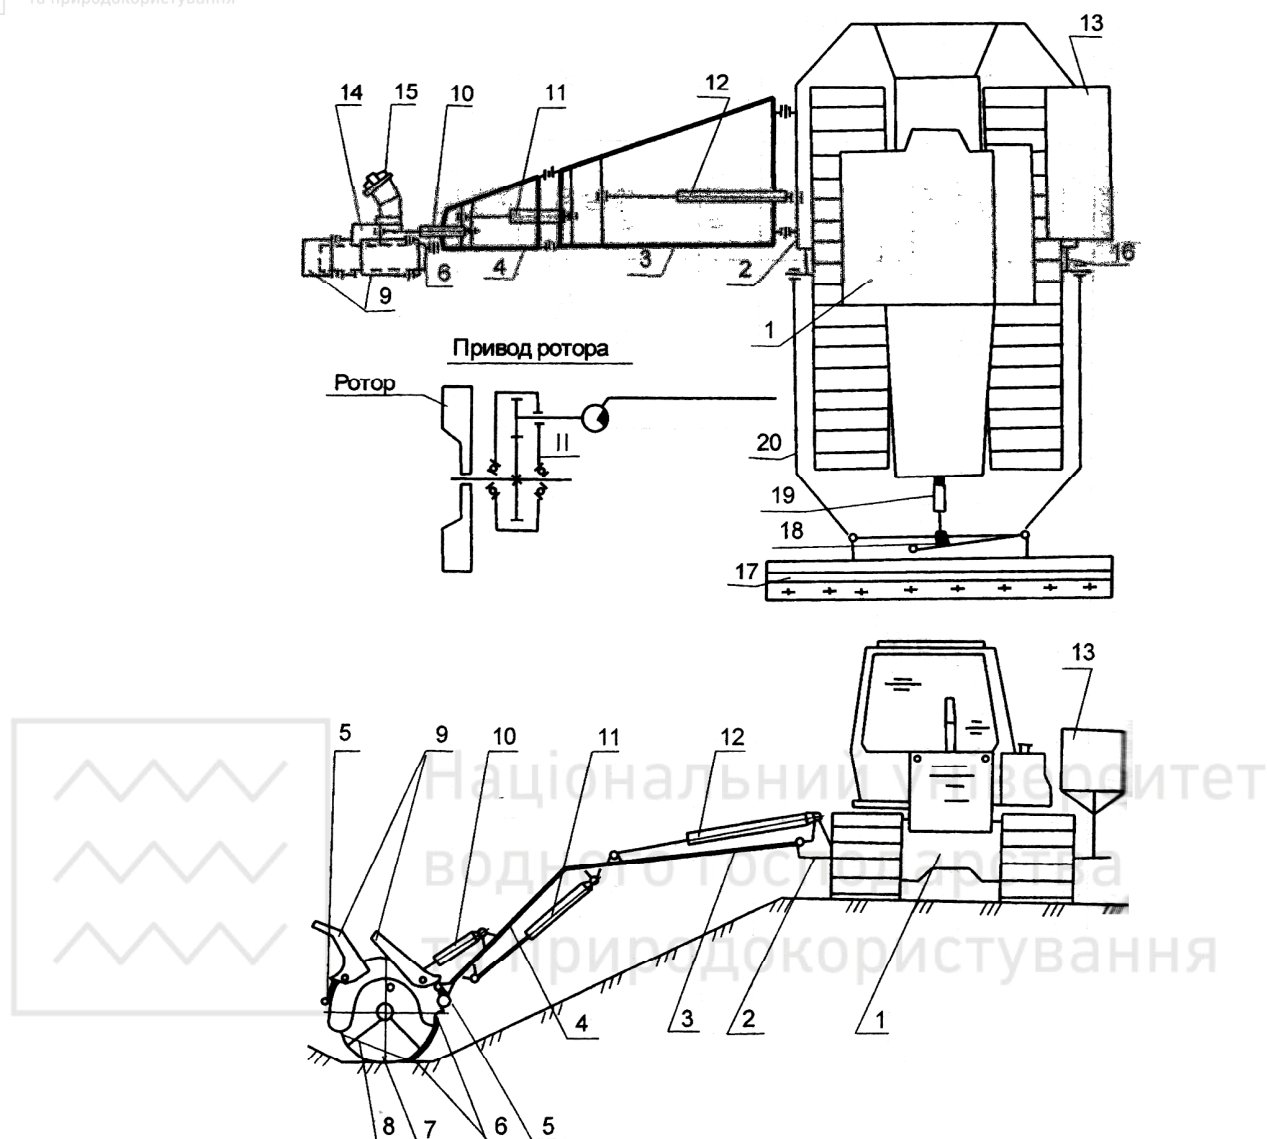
Схема каналочишувача МР-14; 1 – базова машина (трактор ДТ-75ВС2); 2 – основна рама; 3 – стріла; 4 – рукоятка; 5 – талреп; 6 – кожух; 7 – металник; 8 – лопаті; 9 – направляючі засувки; 10-12, 19 – гідроциліндри; 13 – бак для масла; 14 – редуктор; 15 – гідродвигун; 16 – балка; 17 – відвал; 18 – рамка; 20 – універсальна рама
